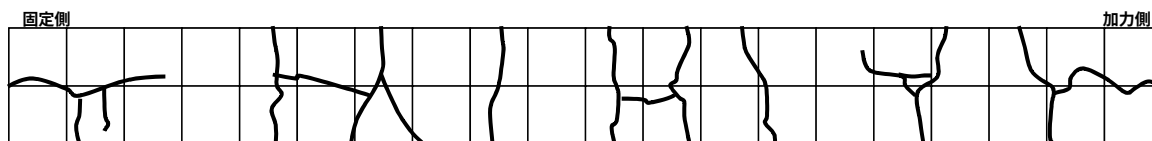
健全試験体のひび割れ発生状況（載荷後）
